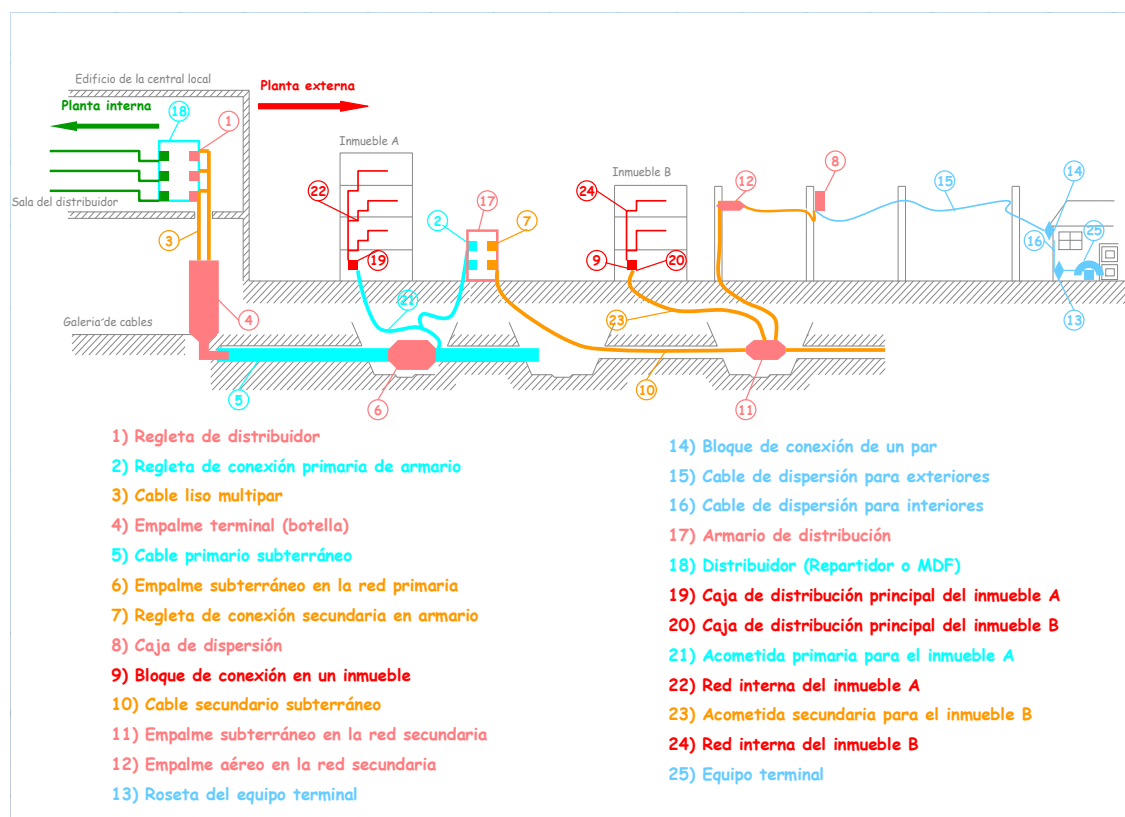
COMPONENTES DE LA PLANTA EXTERNA[14]
